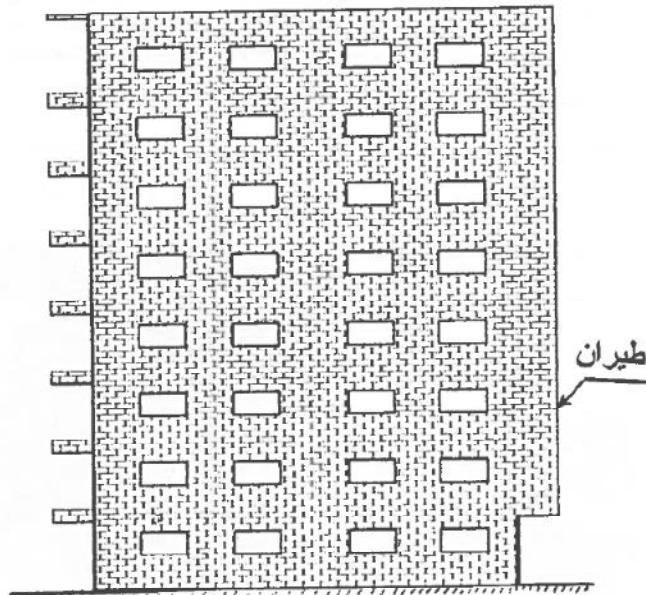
إنهيار الطابق الأرضي طابق رخوه، تشكيل طابق رخوه
